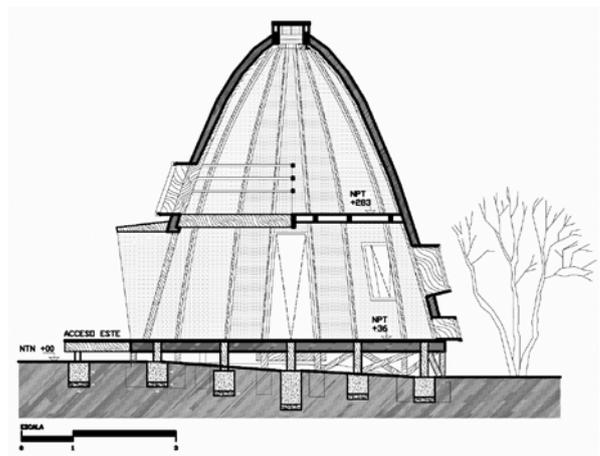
Sección donde se puede observar detalle del espacio interior y relación con el terreno natural
